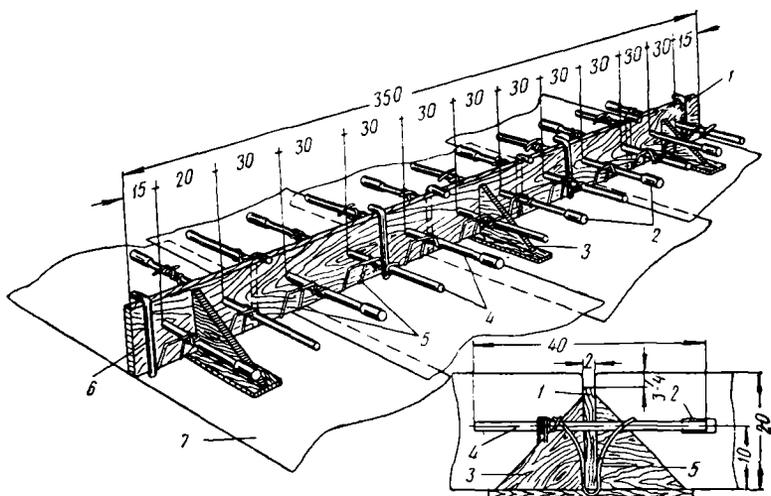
Крепление прокладок и штырей в швах при устройстве цементобетонных покрытий:
